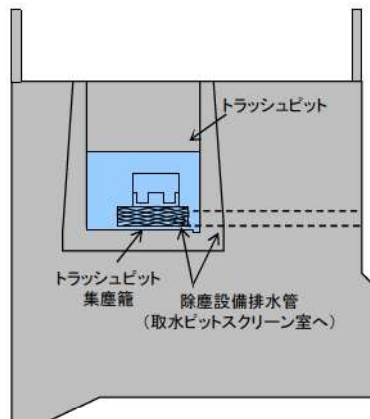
1号及び2号炉取水系統 流入対策配置図 (A-A 断面図)
